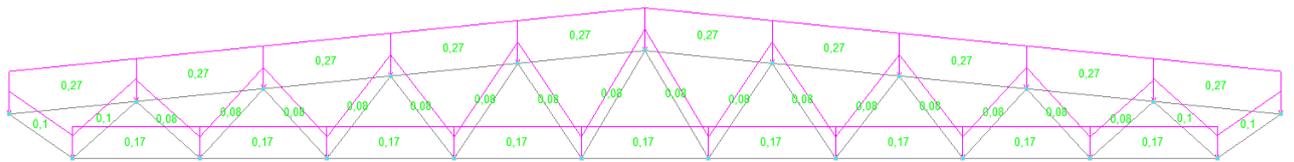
Нагрузки на стропильную ферму от собственного веса
